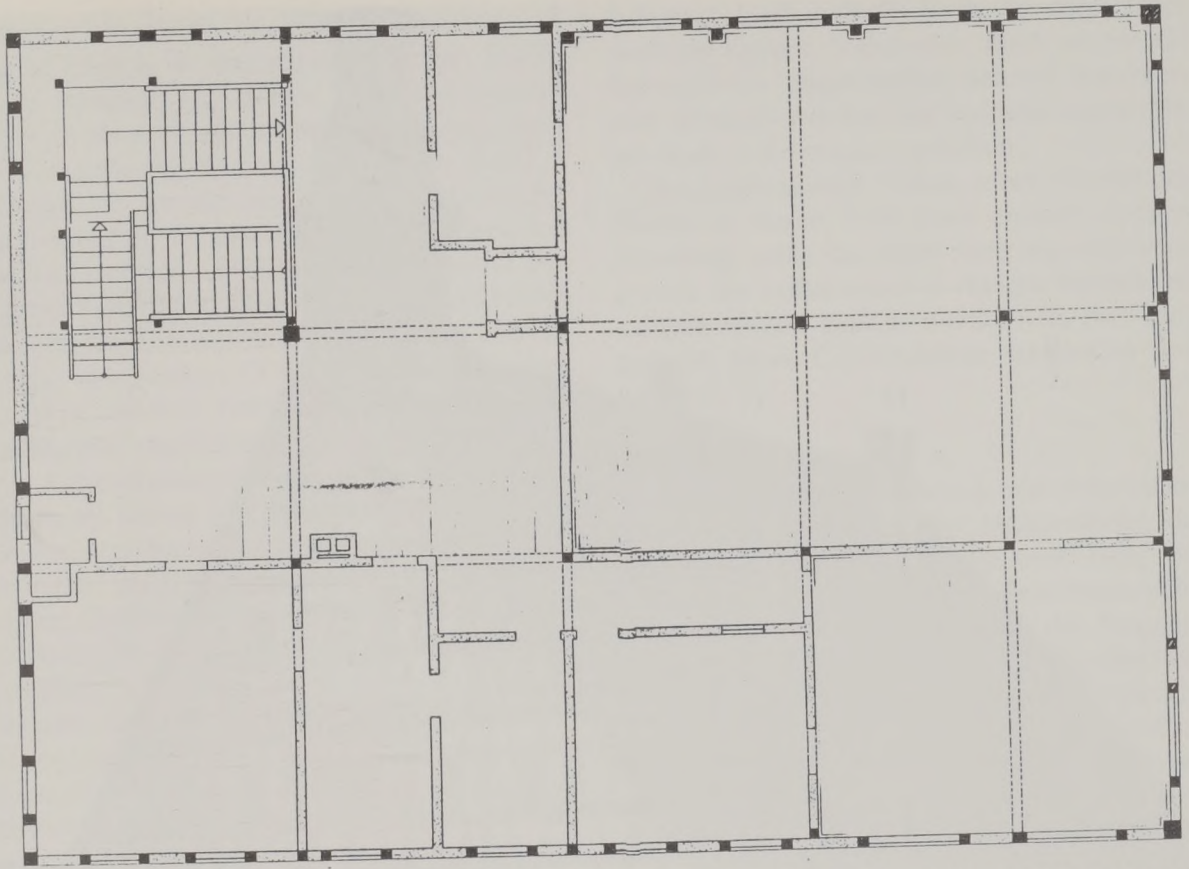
Grundriß des zweiten Obergeschosses, Bauaufnahme von Reiner Serve, 1953 (Institut für Baugeschichte der Universität Stuttgart).
